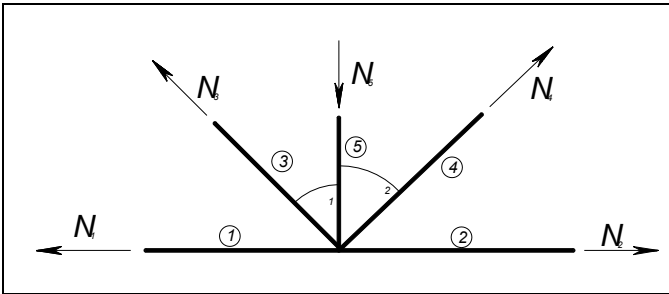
Вузел нижнього поясу, схема № 2
